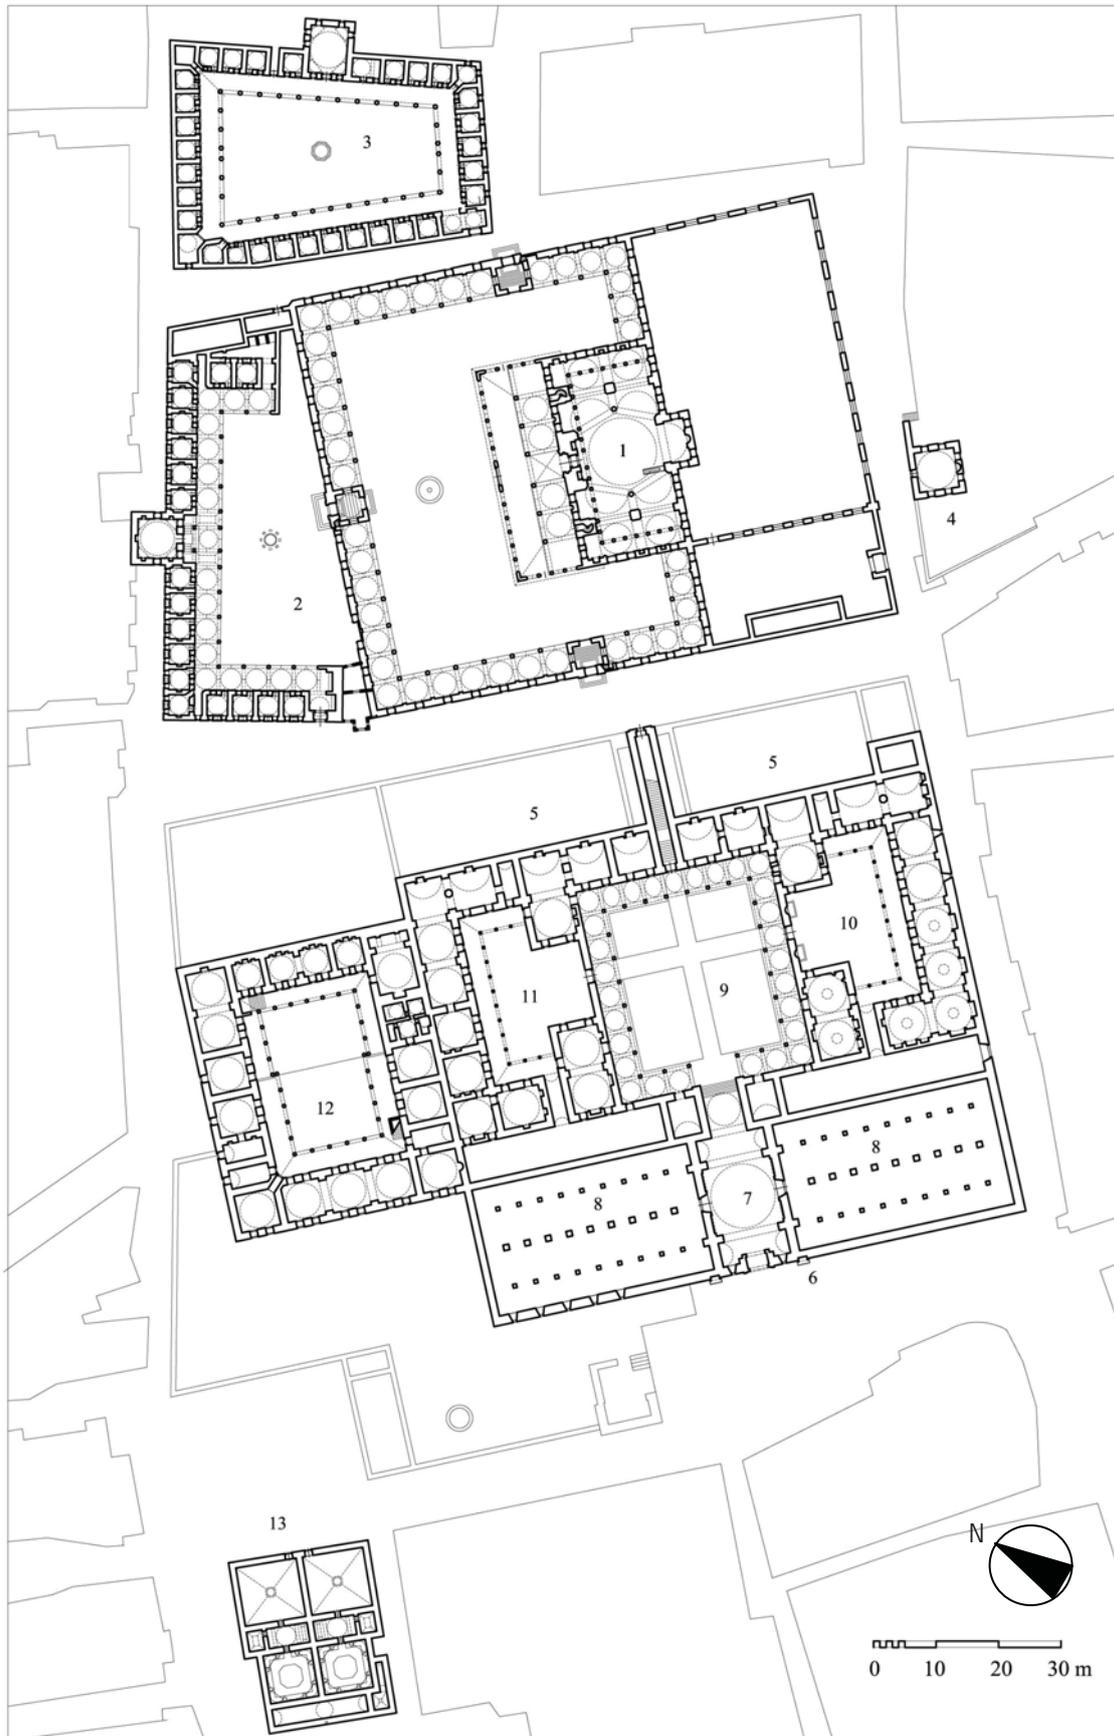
Grundriss und Lageplan, 1579: 1) Moschee 2) Madrasa 3) Derwishhaus 4) Schule 5) Theologische Hochschulen 6) Brunnen 7) überkuppelter Eingangsbereich 8) Karawanserei 9) Mittelhof 10) Speisehaus 11) Herberge 12) Krankenhaus 13) Hamam
